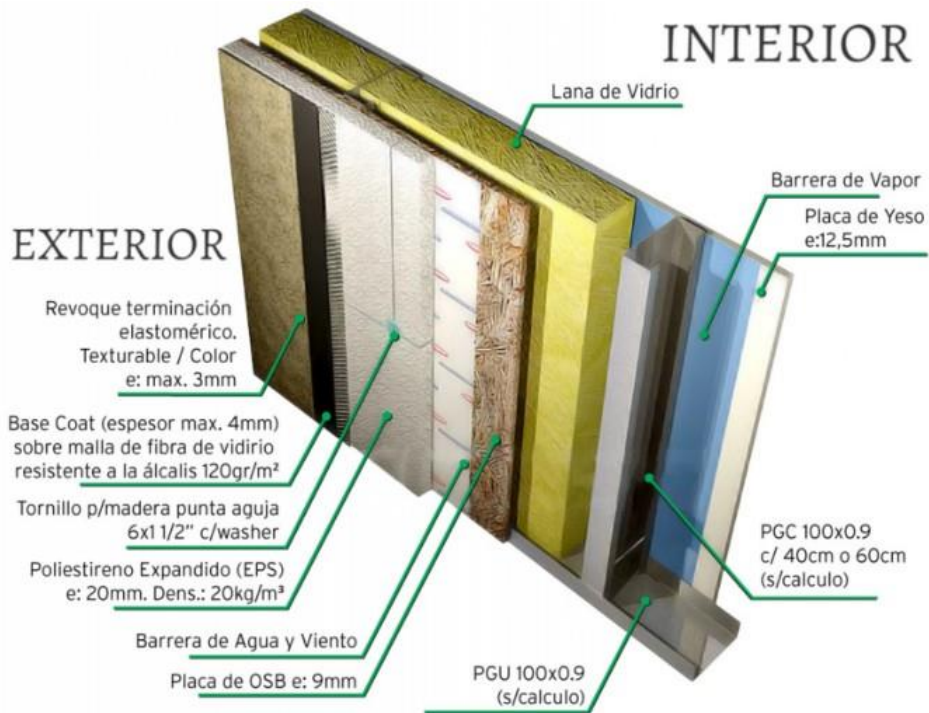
Pared construida con el método Steel framing. Fuente: Empresa Arquitectura Steel.
